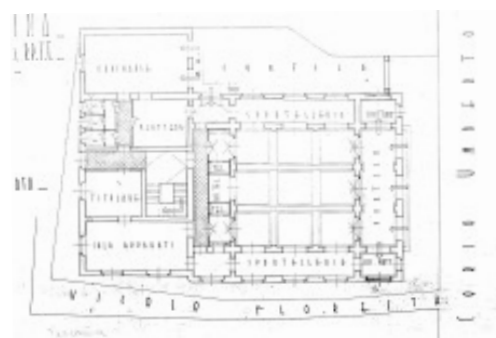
Grundriss des Palazzo in Taormina
